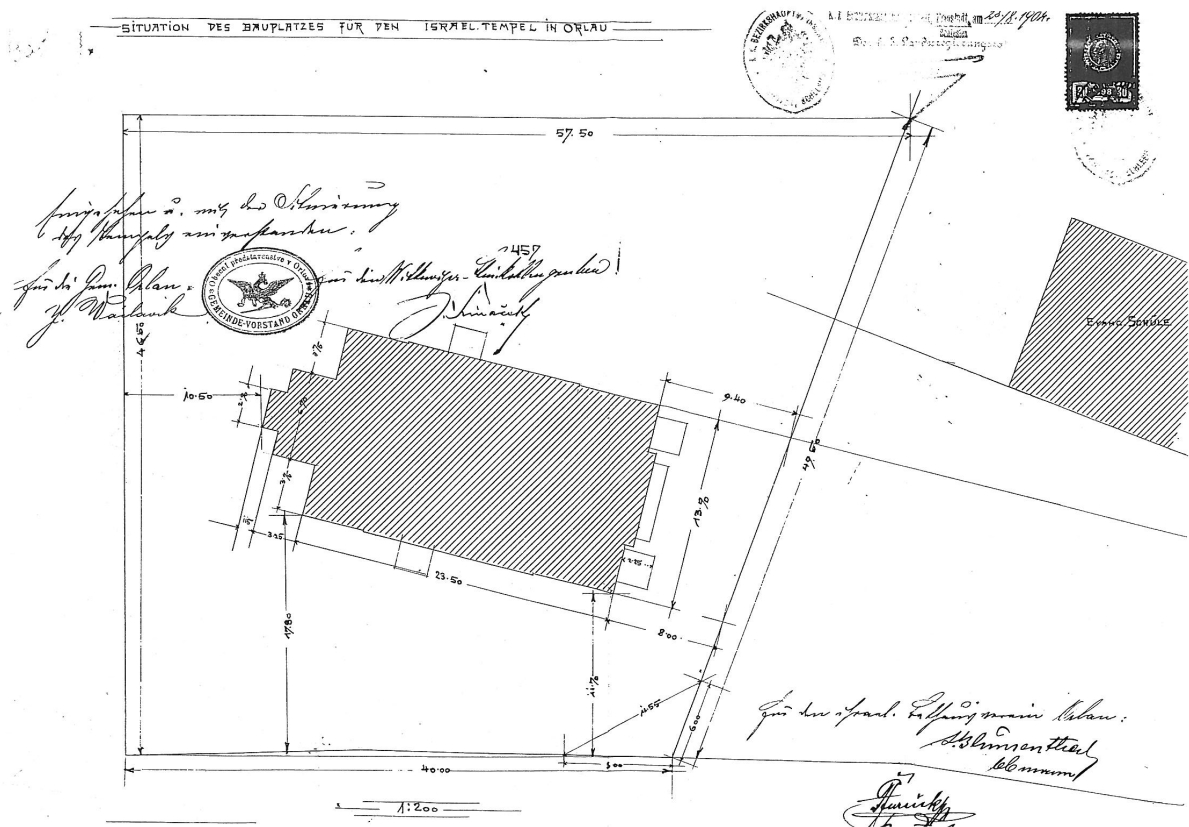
Lageplan M 1:200 aus 1904 (wurde nicht genordet)
